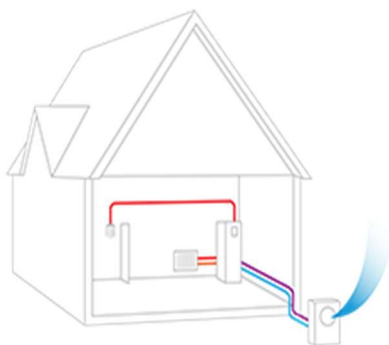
Hur jordvärmens installationsslangar installeras (till höger). (Thermia, u.d.)
